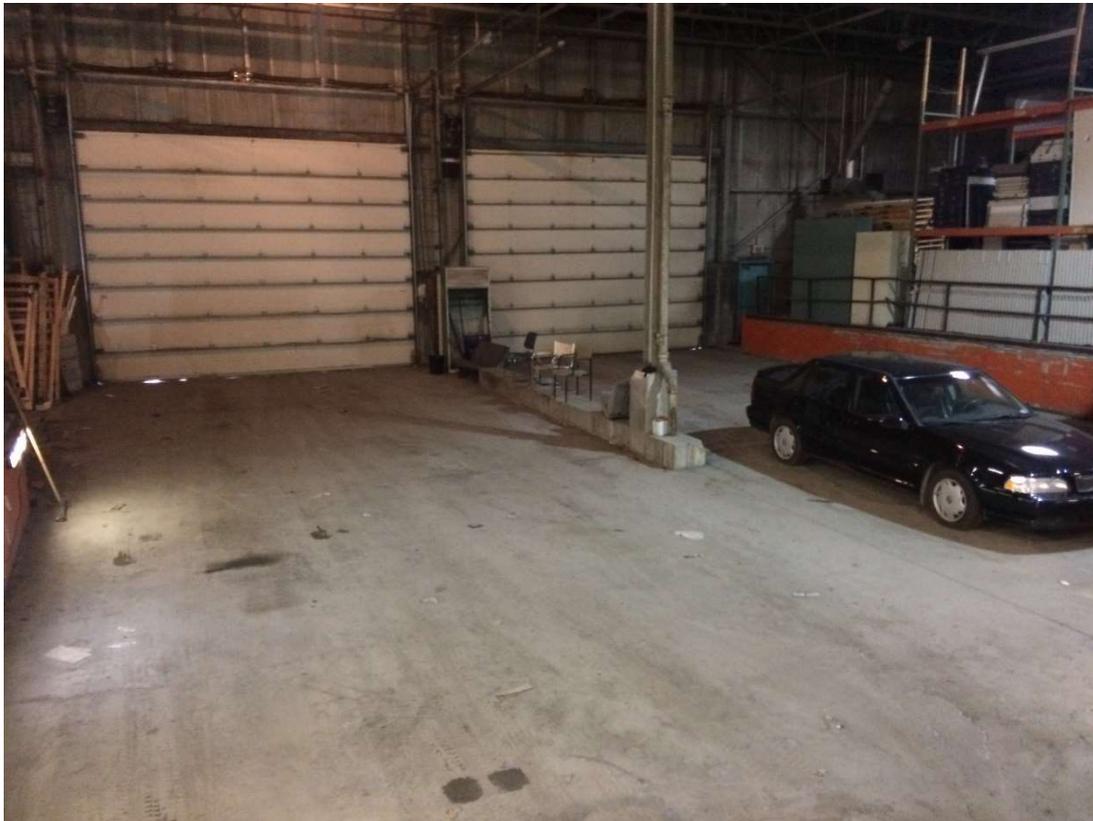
Rehaussement de la dalle sur sol pour, si requis, déplacer les débarcadères vers l'extérieur du bâtiment
